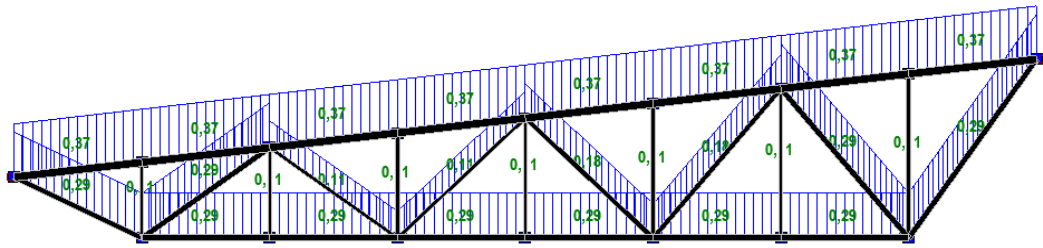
Загрузка №2 собственным весом фермы, кН/м
